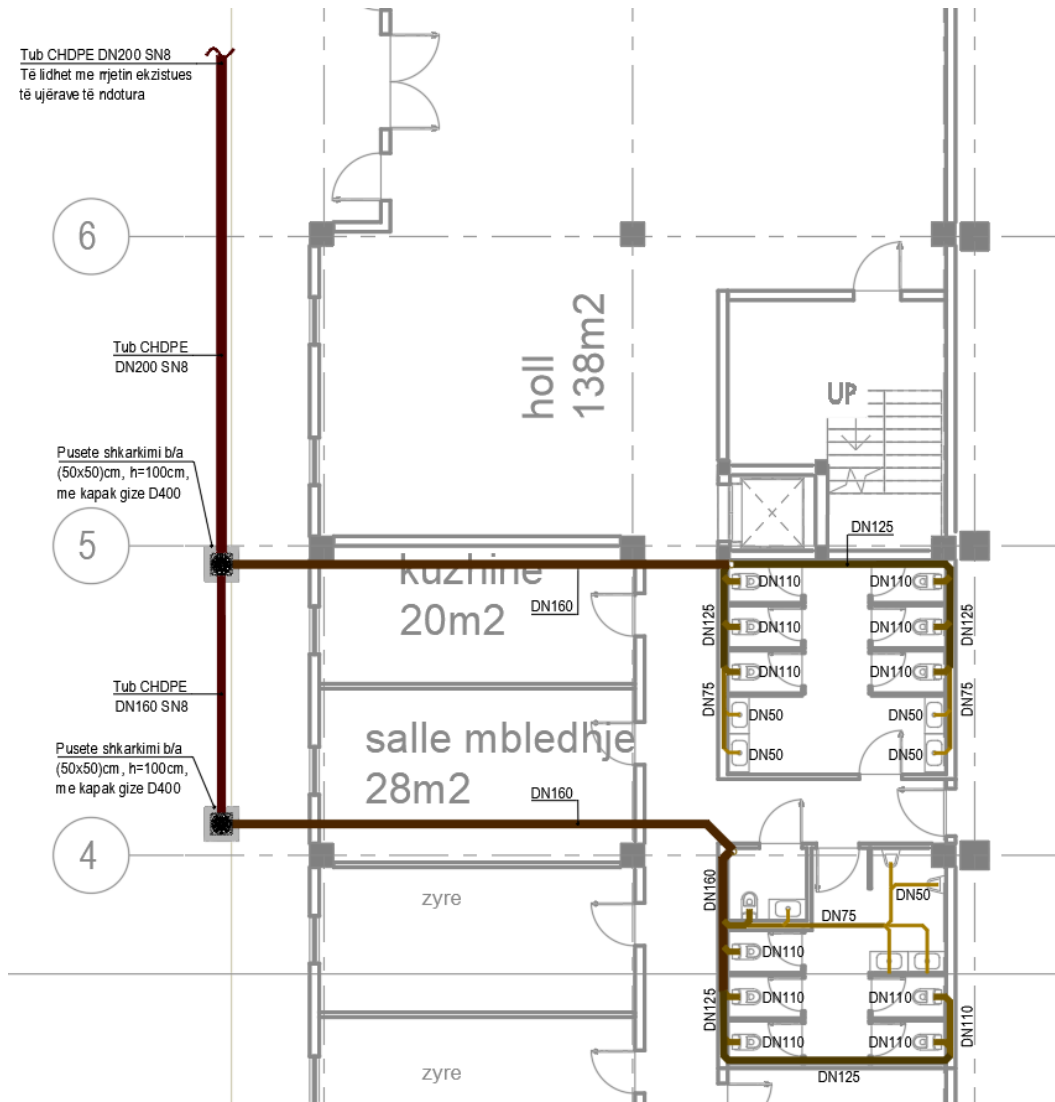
Planimetria e Shkarkimit te Ujërave te Ndotura te Nyjes Sanitare ne zyra
